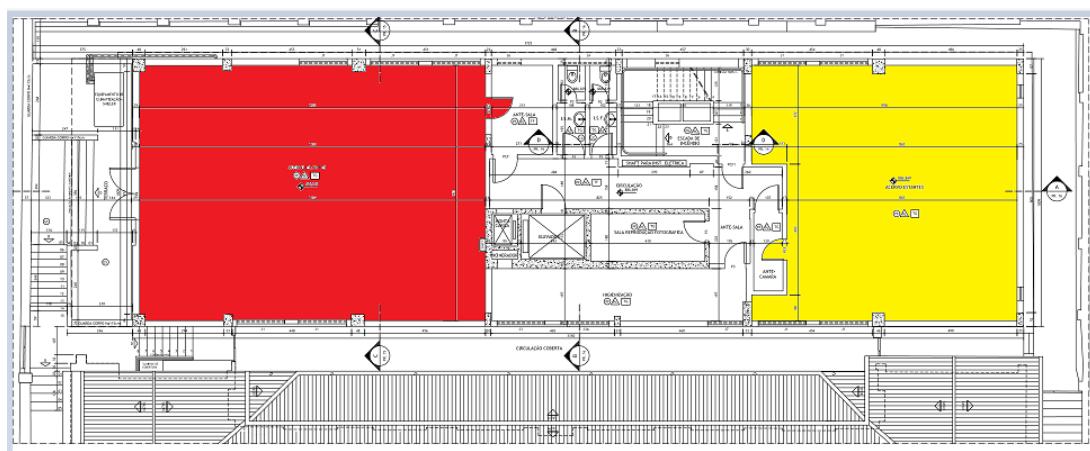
Planta baixa - 2º pavimento: salas 201 e 202.
